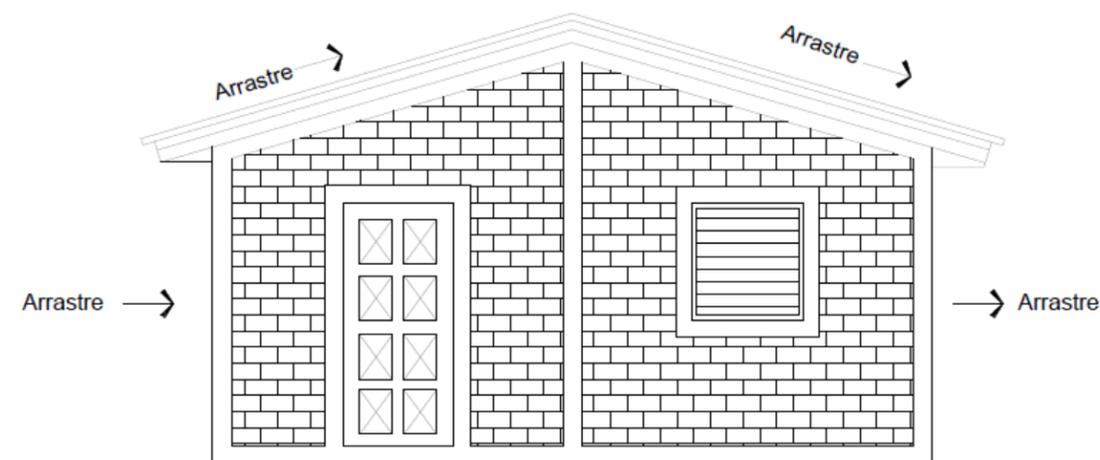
Vivienda ante fuerza de arrastre. Fuente: equipo de trabajo
